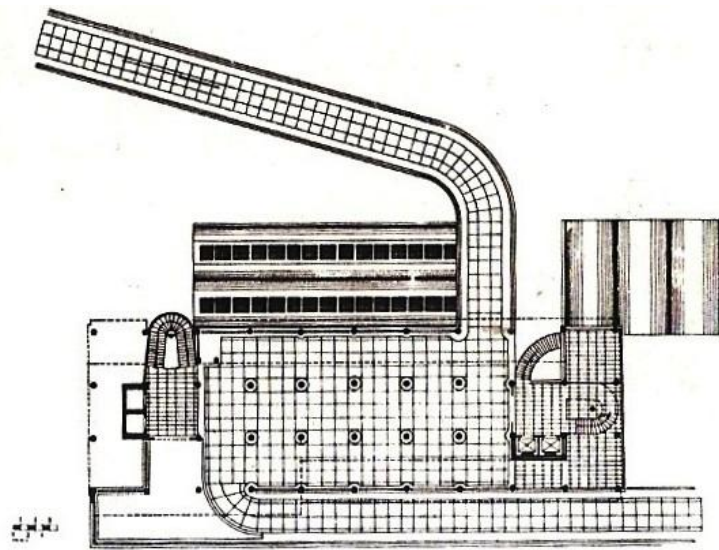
Grundriss des Obergeschosses, Parkplatz.
